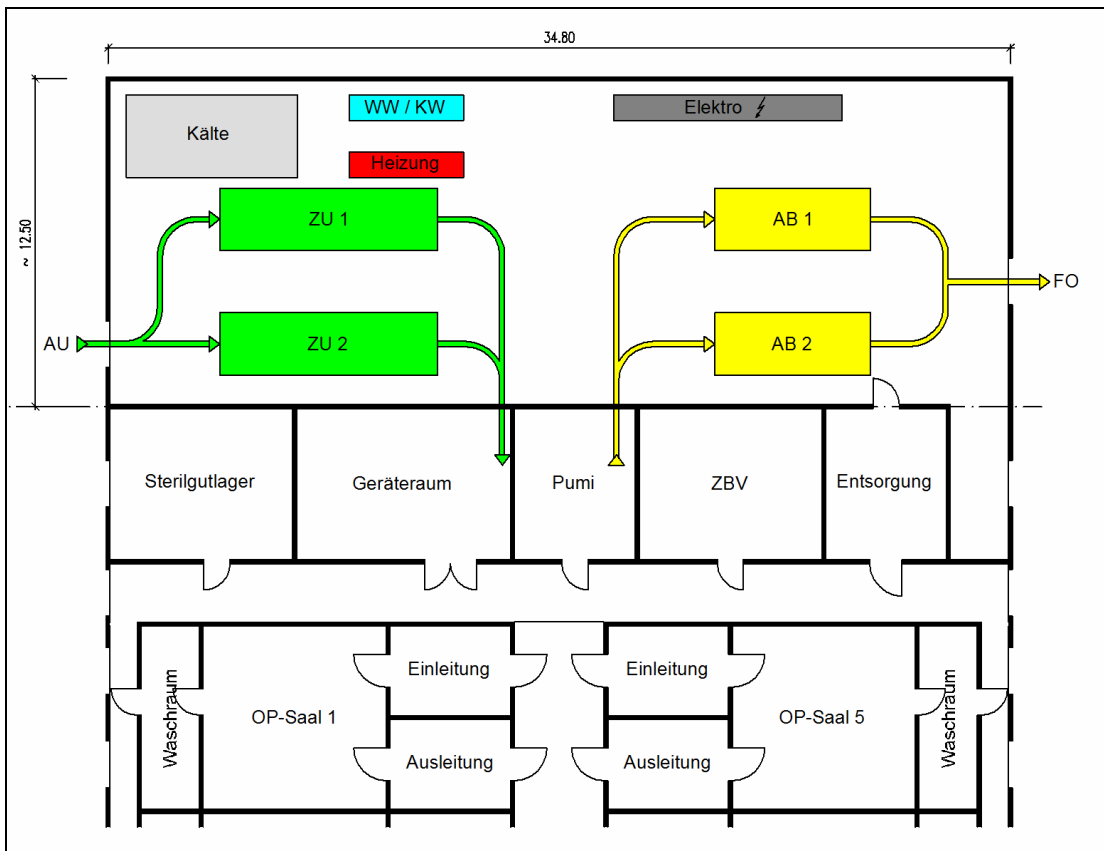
/2: Grundriss - Technikzentrale neben der OP-Abteilung,
